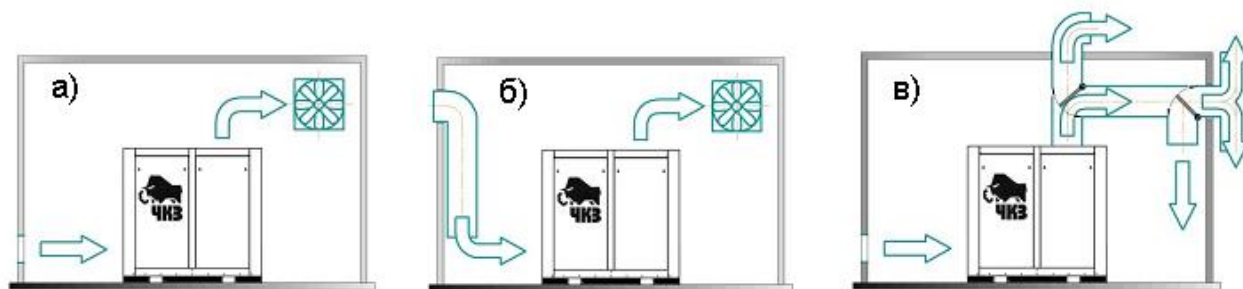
Варианты компрессорного помещения с искусственной аэрацией воздуха: а) – с использованием вентилятора; б) – с использованием вентиляционного короба и вентилятора; в) – с использованием воздуховода и системы заслонок.
